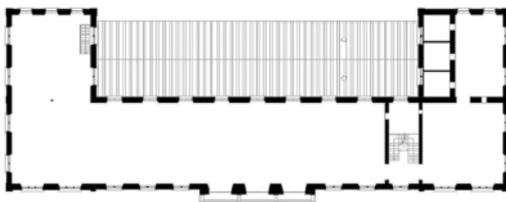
Planta tercera. Edificio original / Edificio Rehabilitado.
